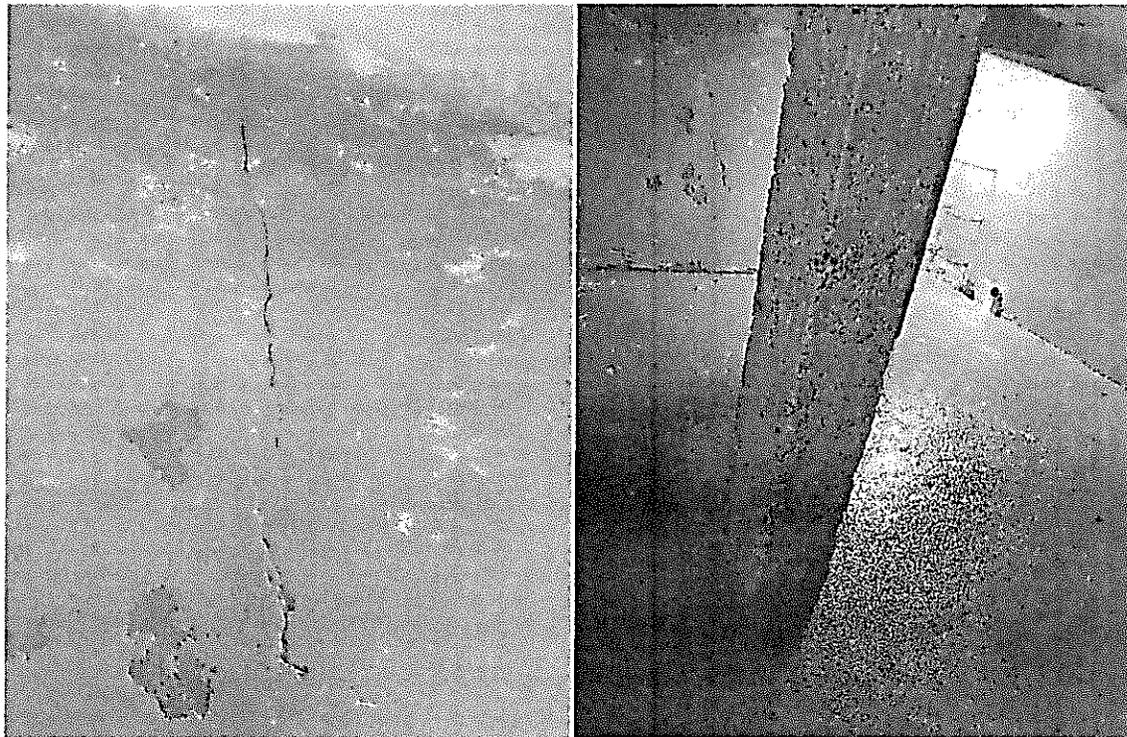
(Izq.) grieta vertical en el muro. (der) Columna deteriorada con pérdida de recubrimiento, fisura compartida en el muro bypass. "fuente propia".
